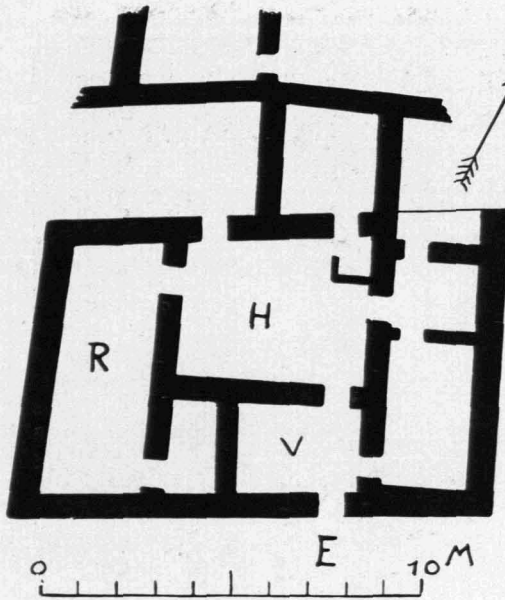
Grundriß eines Hauses in Farah (Schuruppak).
